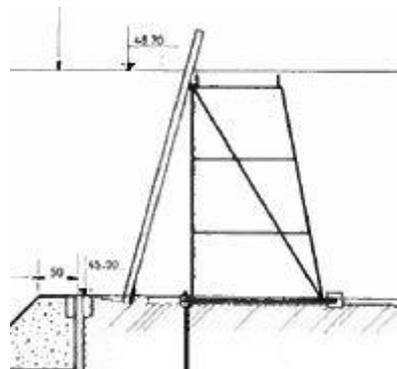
Coupe Transversale : aiguilles en support sur une armature métallique de type fermette (1860 à 1980)
